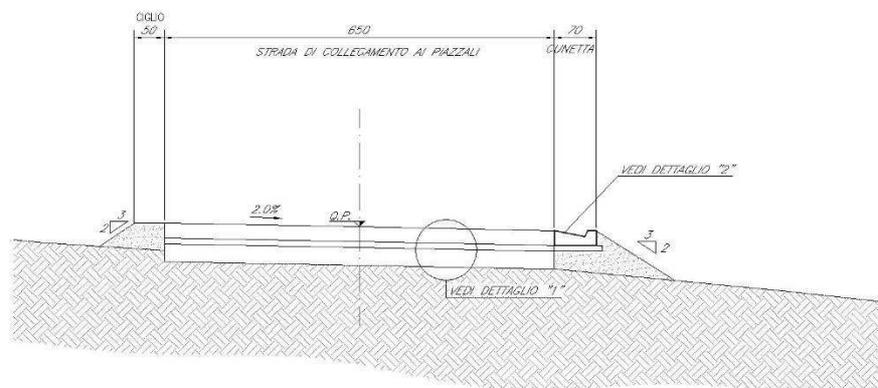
Stralcio sezione tipo viabilità di cantiere
